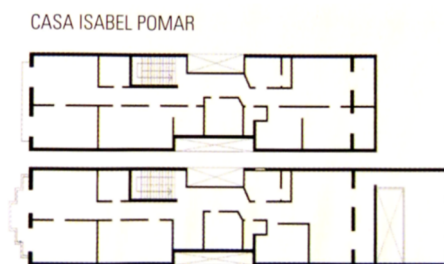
Plano del edificio - 1 vivienda por planta (fuente "Cerdà i la Barcelona del Futur")
